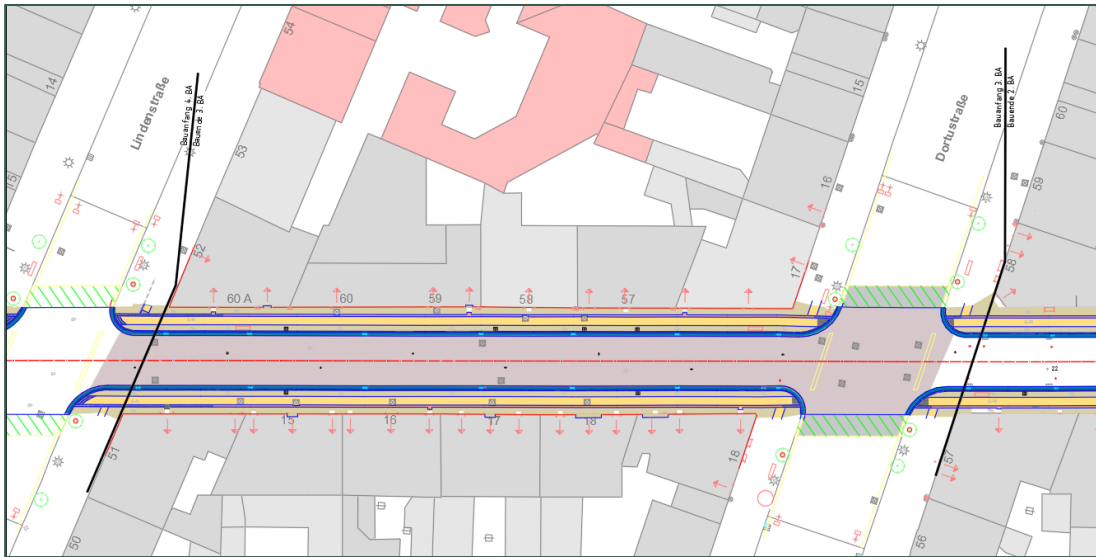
Baubereich Straßenbau Kreuzung Dortustraße bis Lindenstraße
